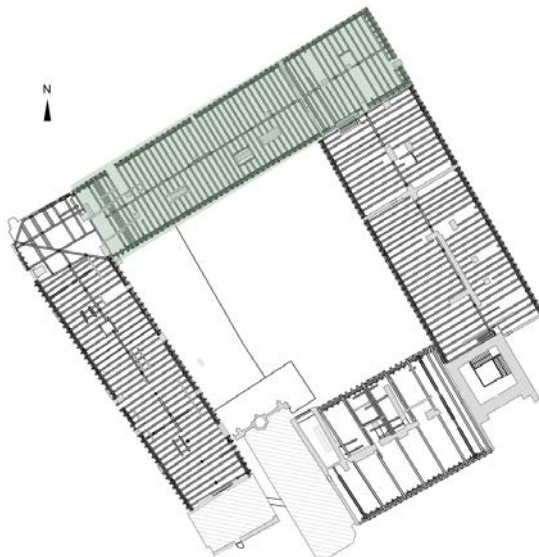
Lageplan Dachwerke Schweizerhof mit Markierung des NW-Trakts
